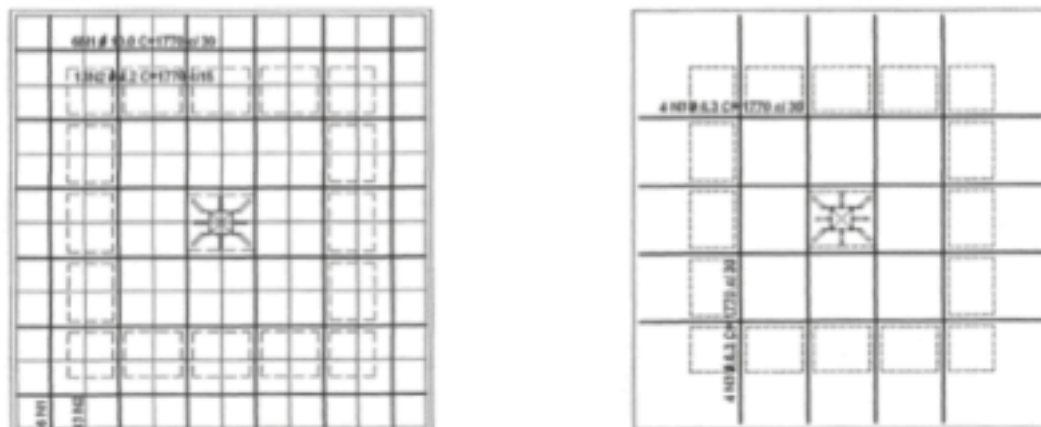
Detalhe do posicionamento em planta da armadura negativa e positiva
